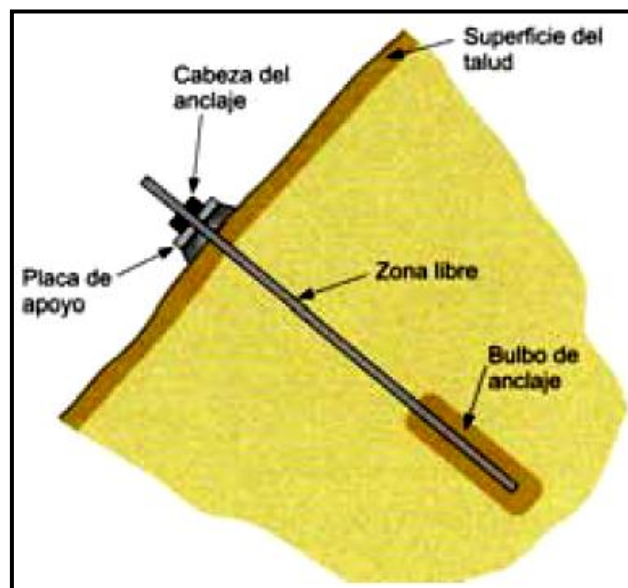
Detalle de un anclaje. Fuente: Google, Anclaje de talud.
